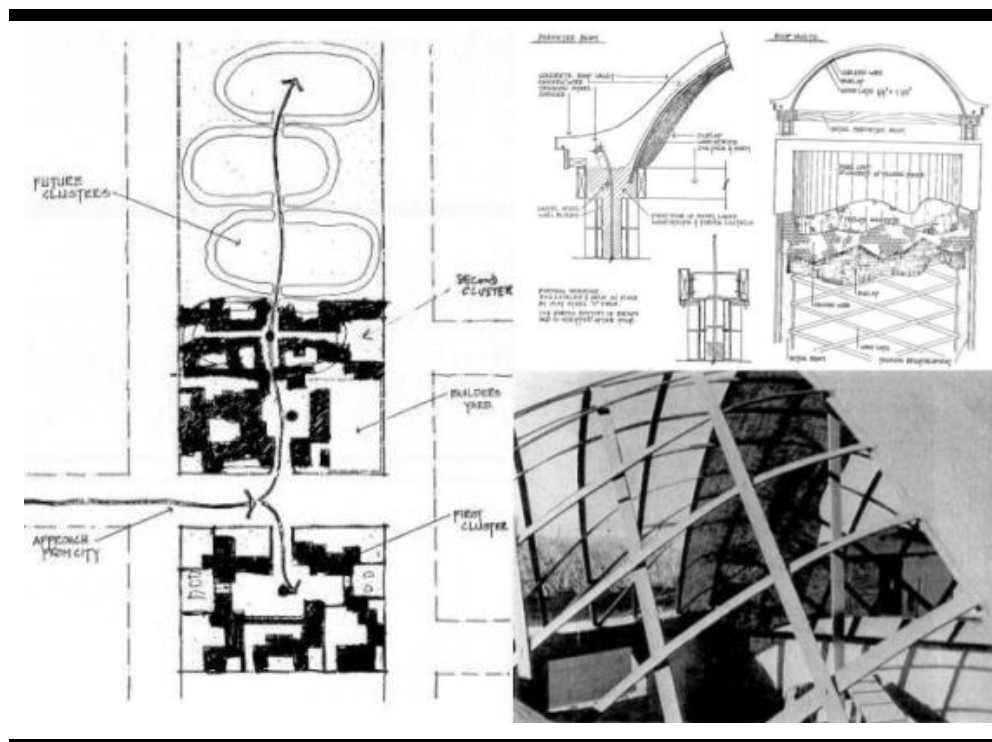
Projeto Mexicali: croquis, detalhe construtivo e imagem da construção.
